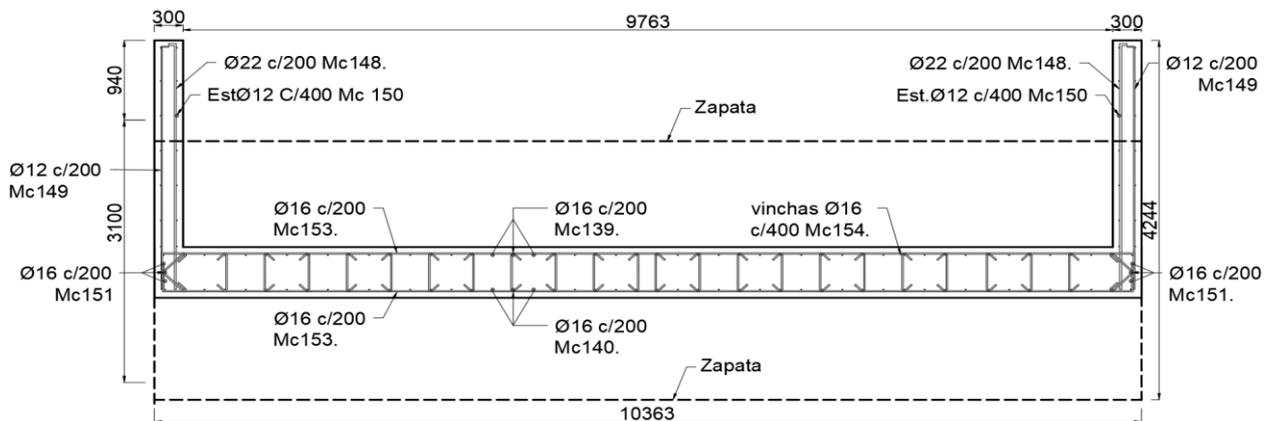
Vista en planta del estribo 2 [Elaboración propia]
